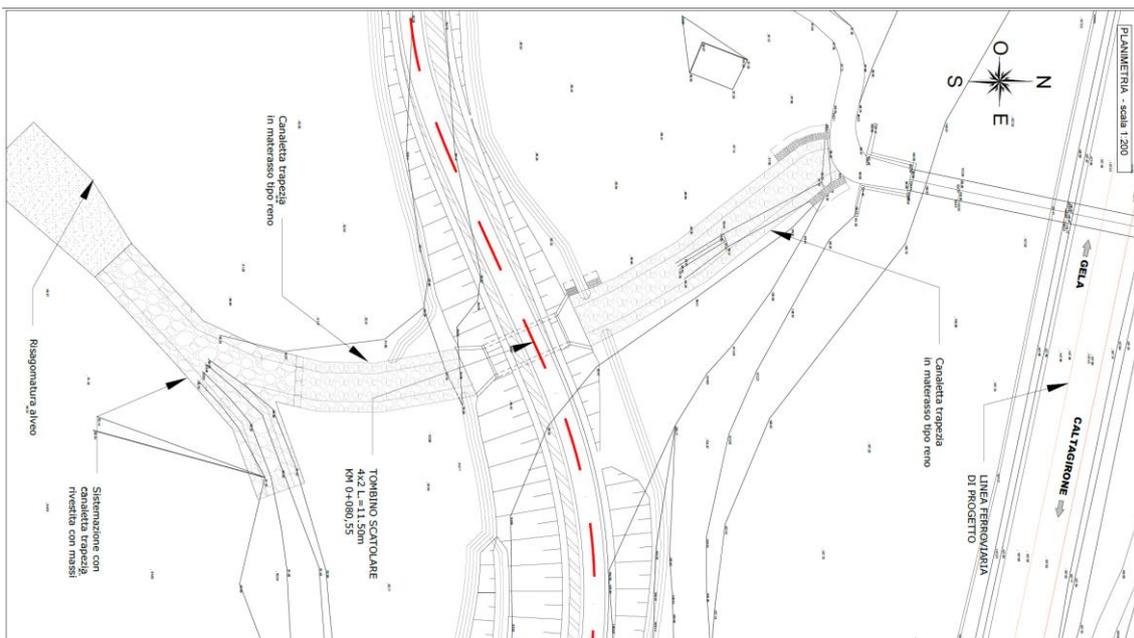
Inquadramento planimetrico Tombino e sistemazione idraulica
